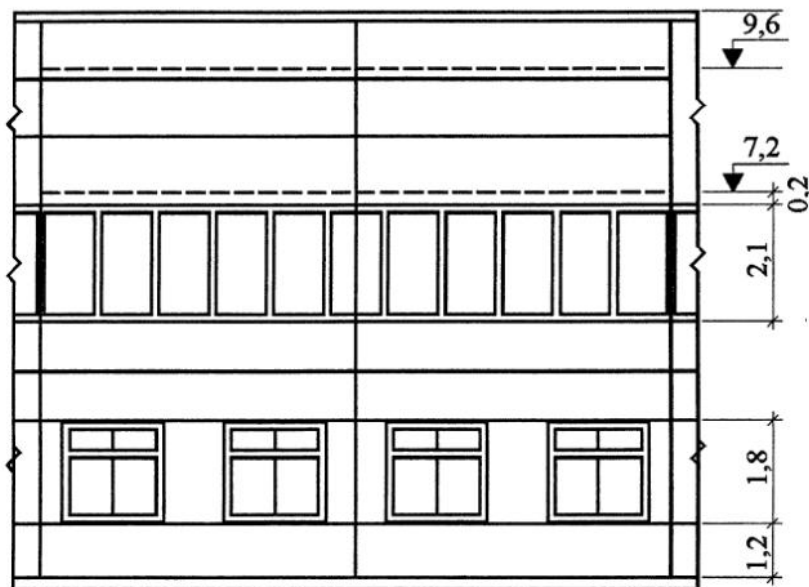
Пример размещения остекления на фрагменте продольного фасада цеха
